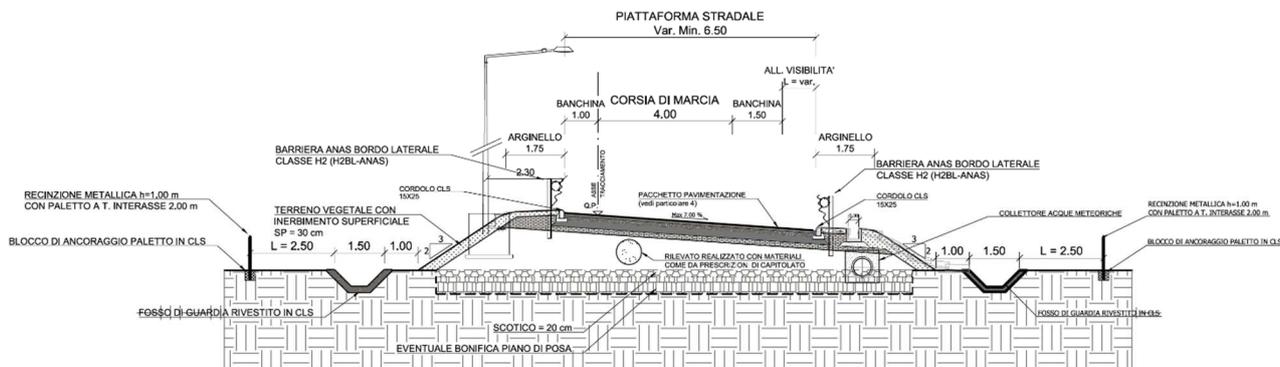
Sezione tipo di rampa monodirezionale in rilevato in rettillo
